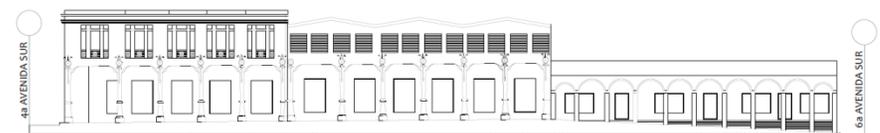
Perfil 2a Calle Oriente (Portal La Dalia, San Salvador)
